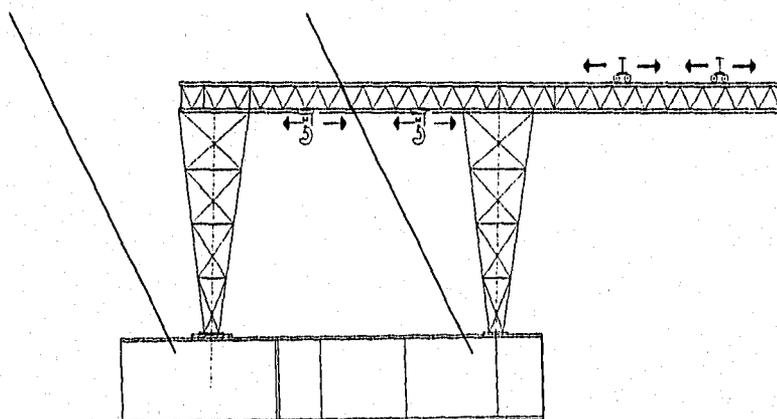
Pórtico de montaje del puente atirantado Barranca el Zapote.
